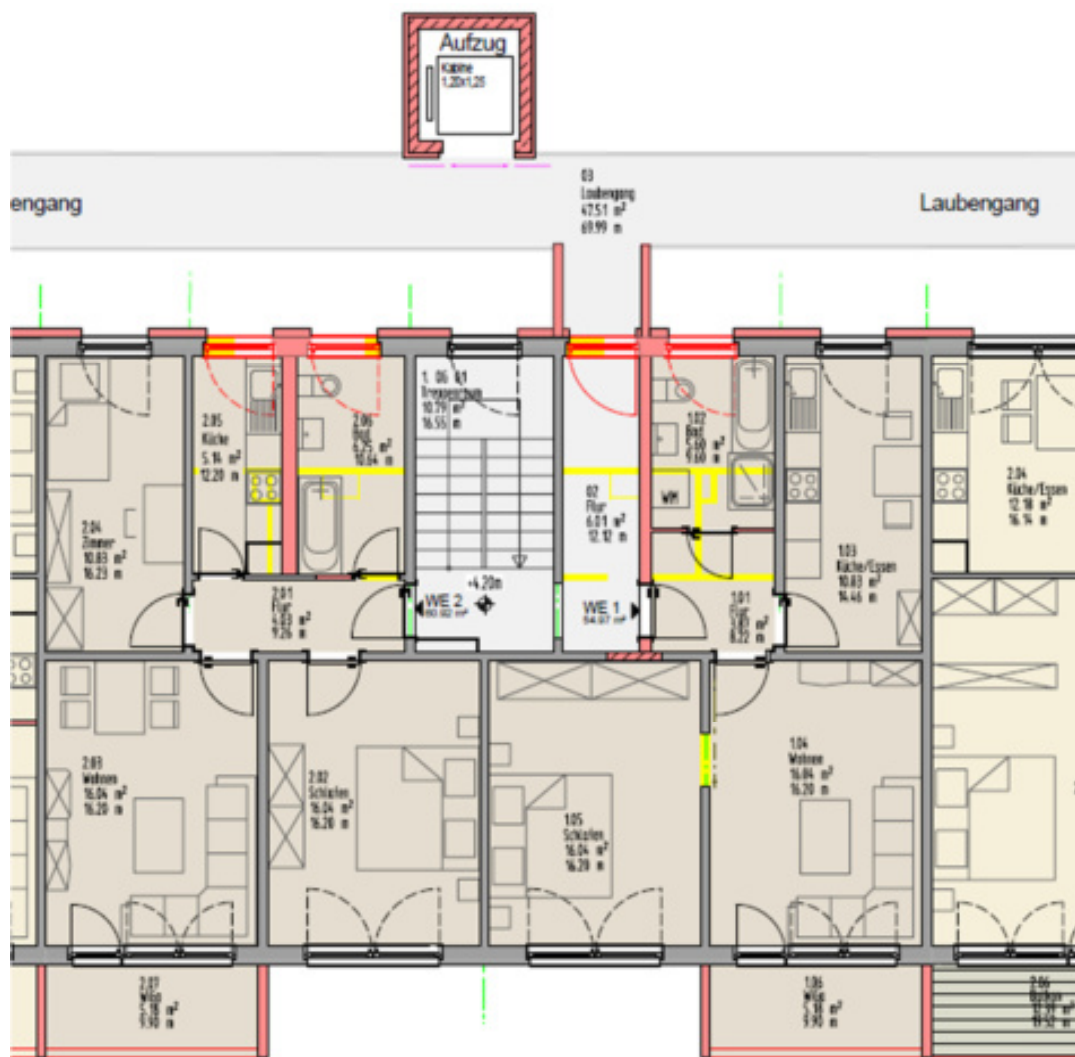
Ausschnitt aus Grundriss zu Var 3 mit Grundrissoptimierung und Laubengang für zentralen Aufzug (Quelle: IBNuP)
